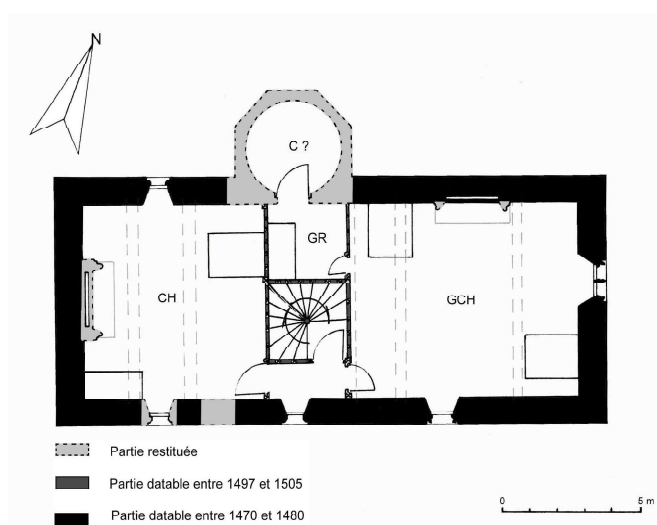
Perriers. Plan restitué du premier étage entre 1497 et 1505.
